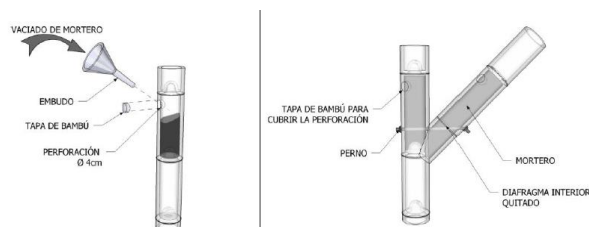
Ligações aparafusadas com argamassa de cimento - (Ministerio de Vivienda, C.y.S.d.P., 2012)
